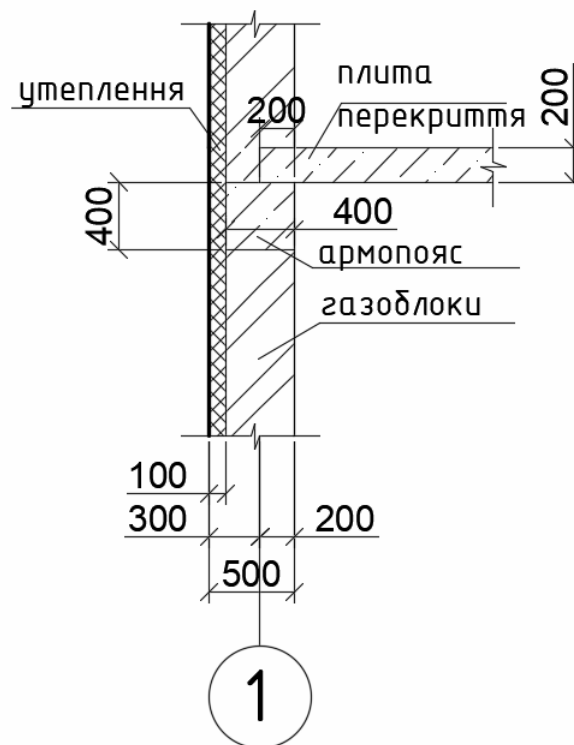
Вузол обпирання плити перекриття на несучу стіну
